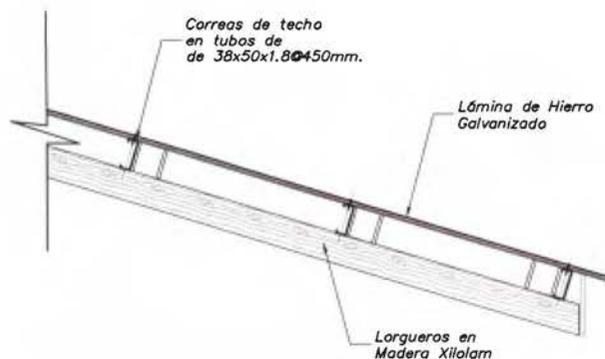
Detalle de la configuración de Cubierta de techo para el Escenario 1, Situación actual en el edificio en estudio. Elaborado por la autora.
